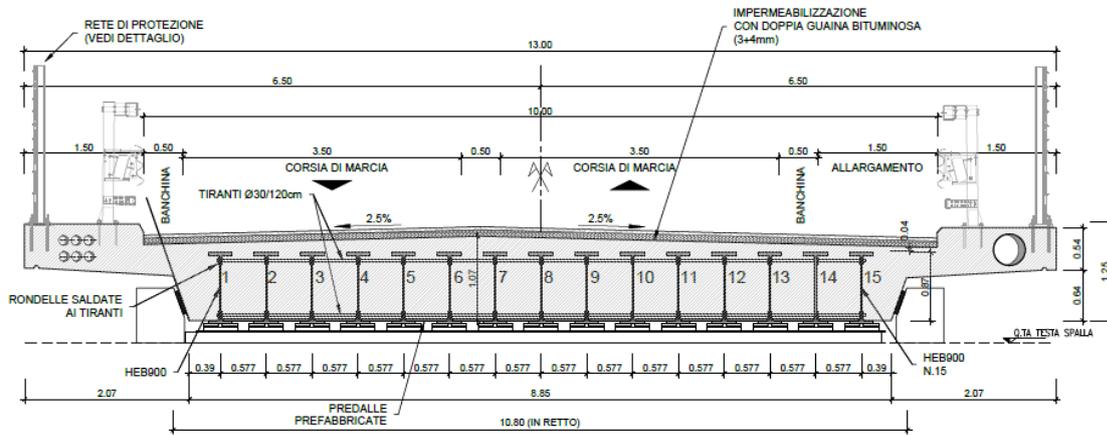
Nuovo cavalcaferrovia nella stazione di Ellera: sezione trasversale
